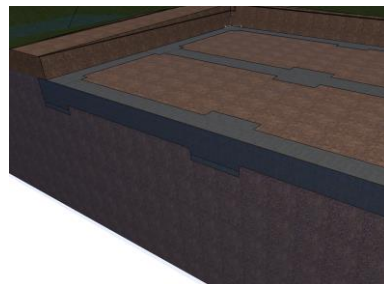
Modelado de la cimentación. LOD 300. Fuente propia Archicad 20. 2018
